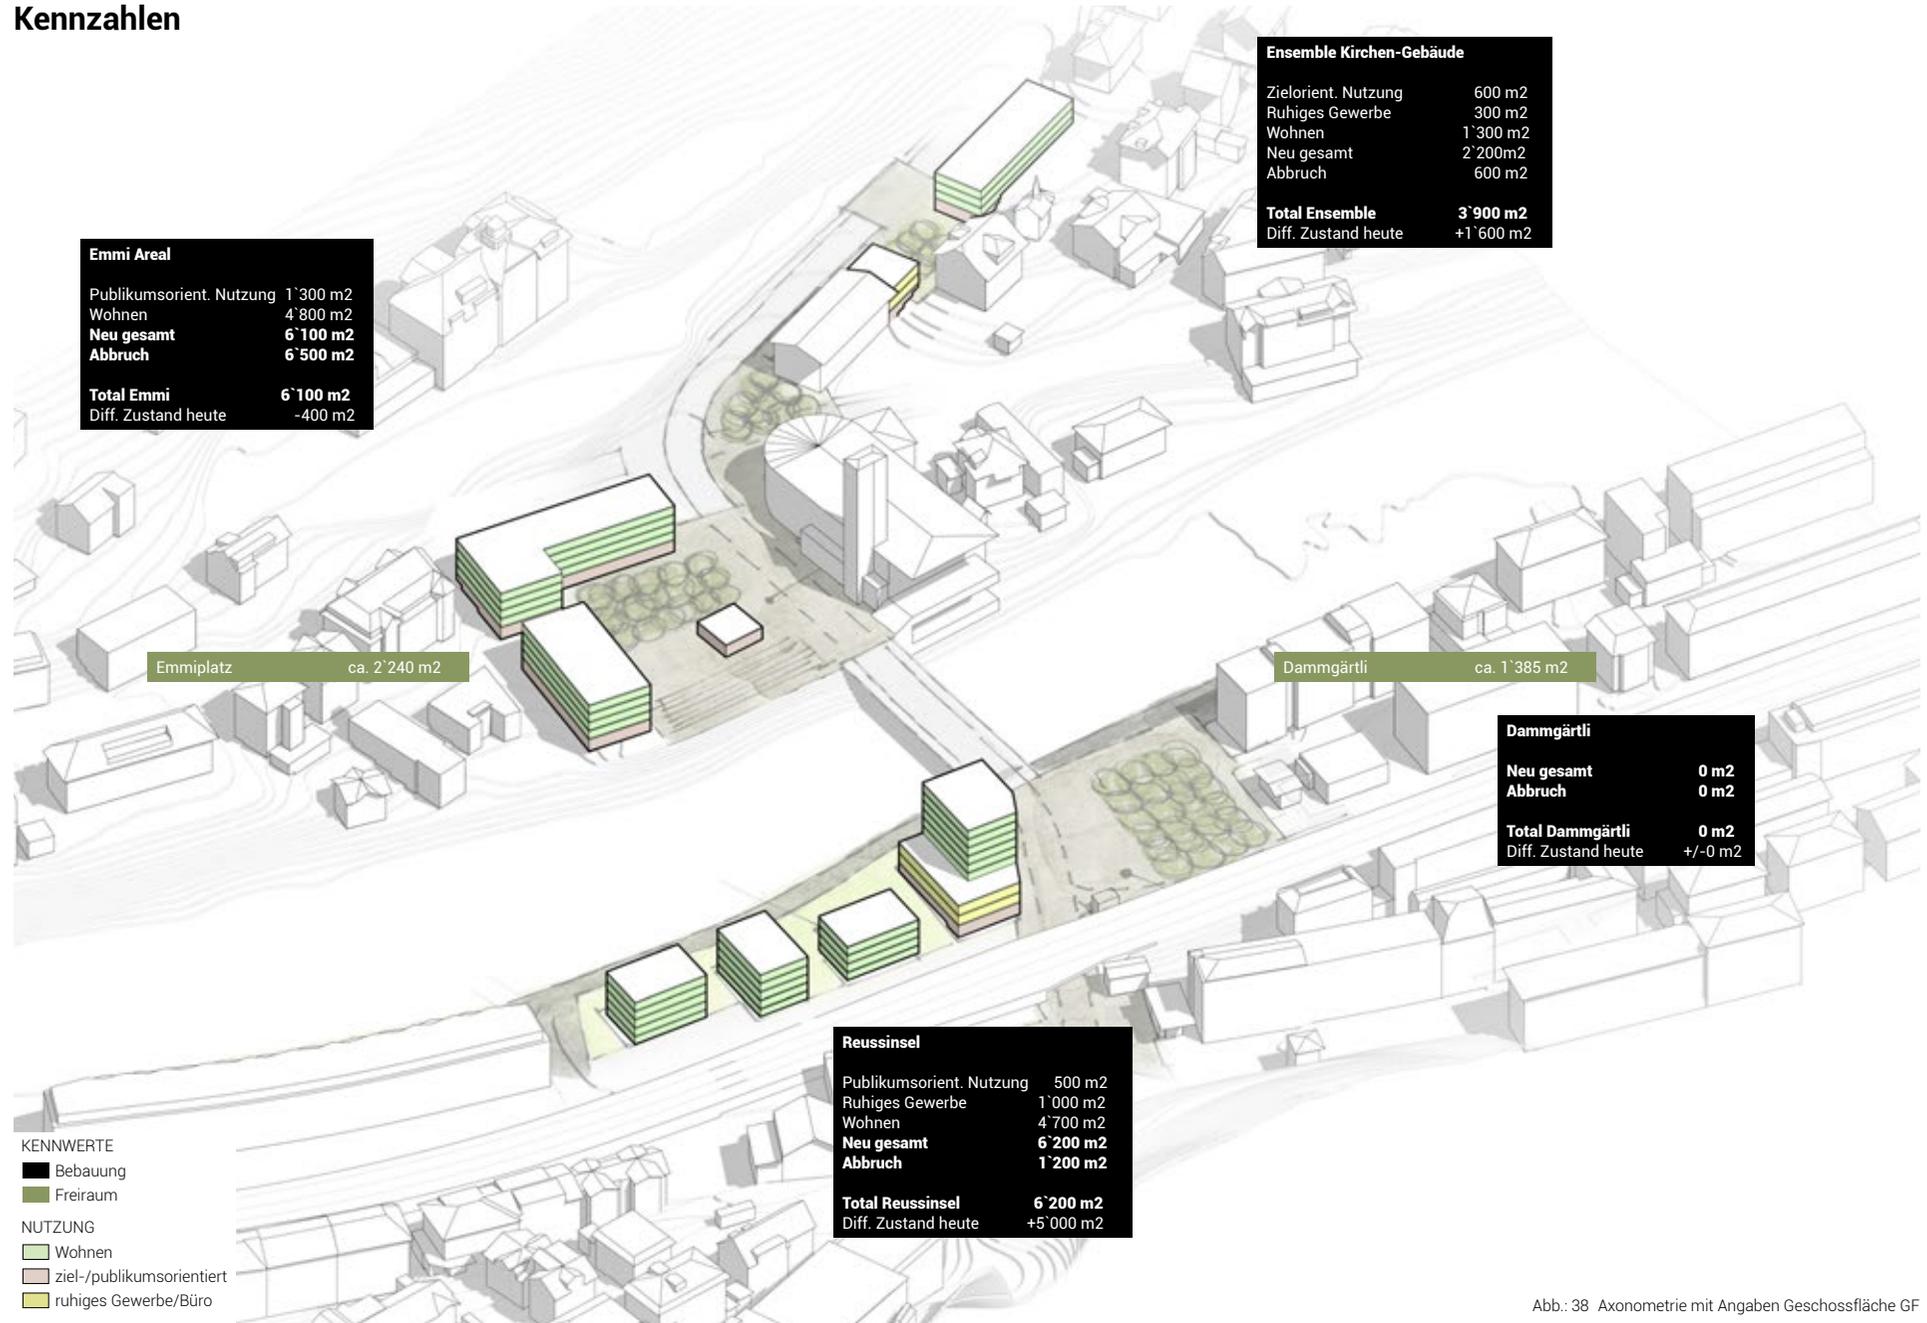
Axonometrie mit Angaben Geschossfläche GF
